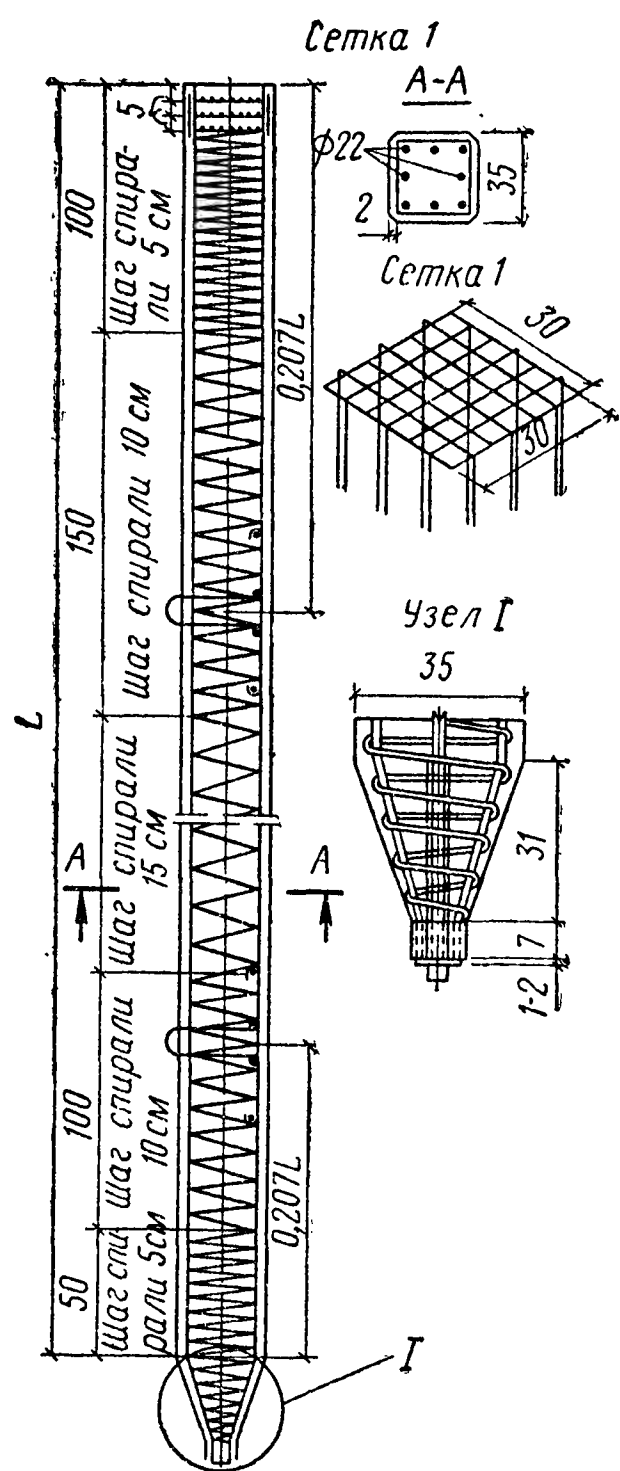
Железобетонная свая квадратного сечения с ненапрягаемой арматурой
